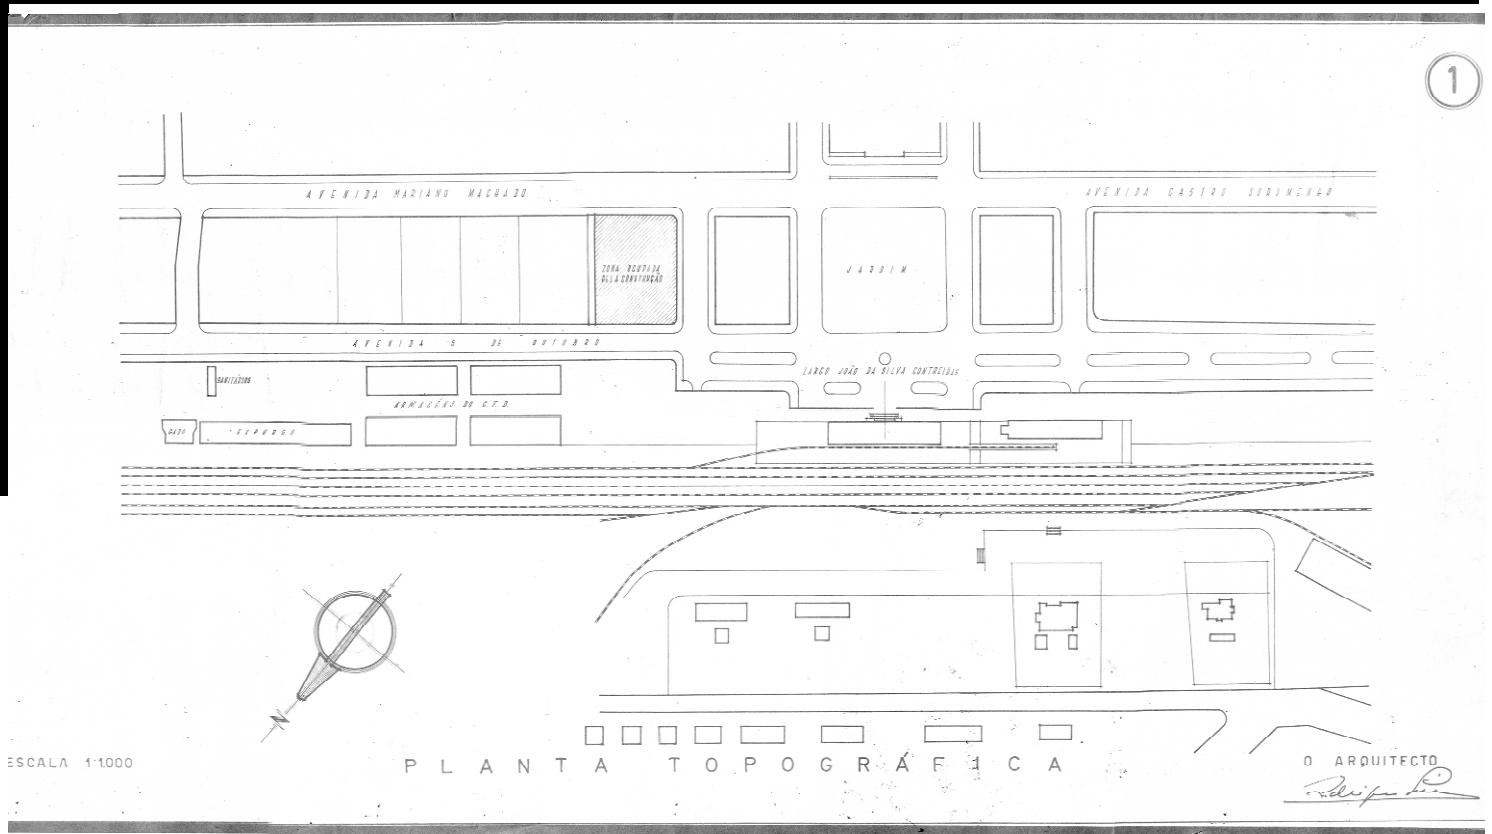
Ruacaná – Planta de implantação, assinado por Arq. Rodrigues Lima
